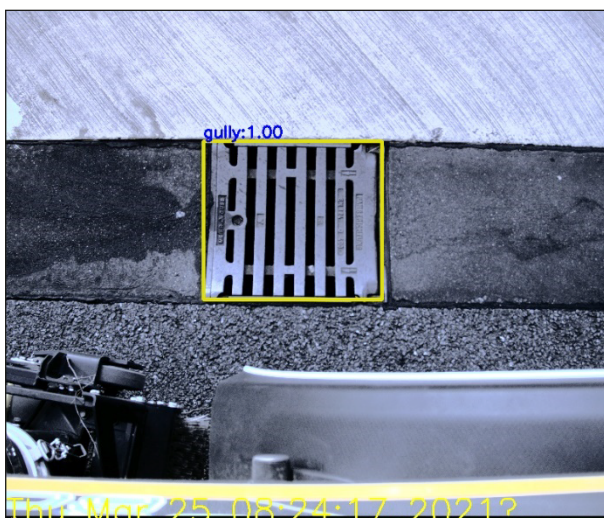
Eindeutig identifizierter Sinkkasten auf einem Autobahnrastplatz (Foto aus Pilotprojekt, iLocator)
